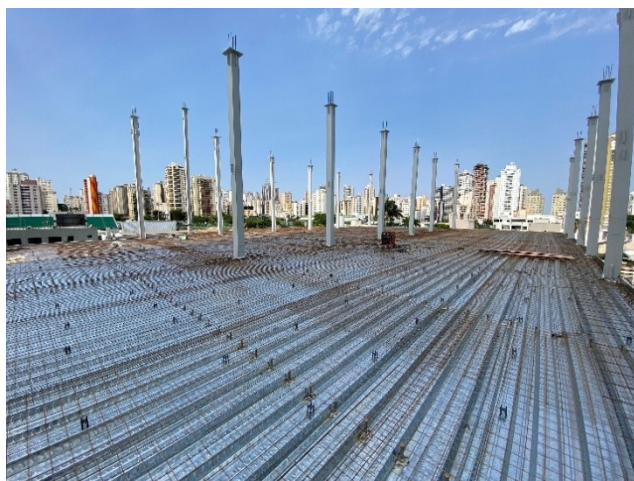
Laje Mista Steel Deck com Armadura - Fonte: Autor
